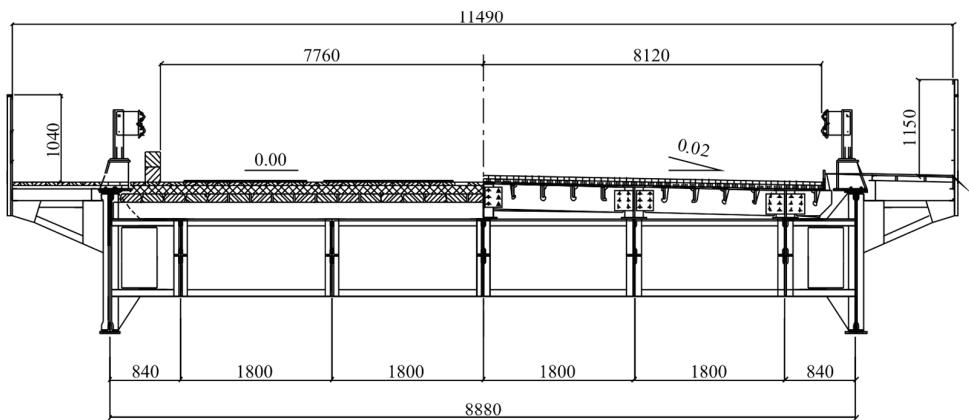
Поперечное сечение пролётного строения до и после реконструкции
